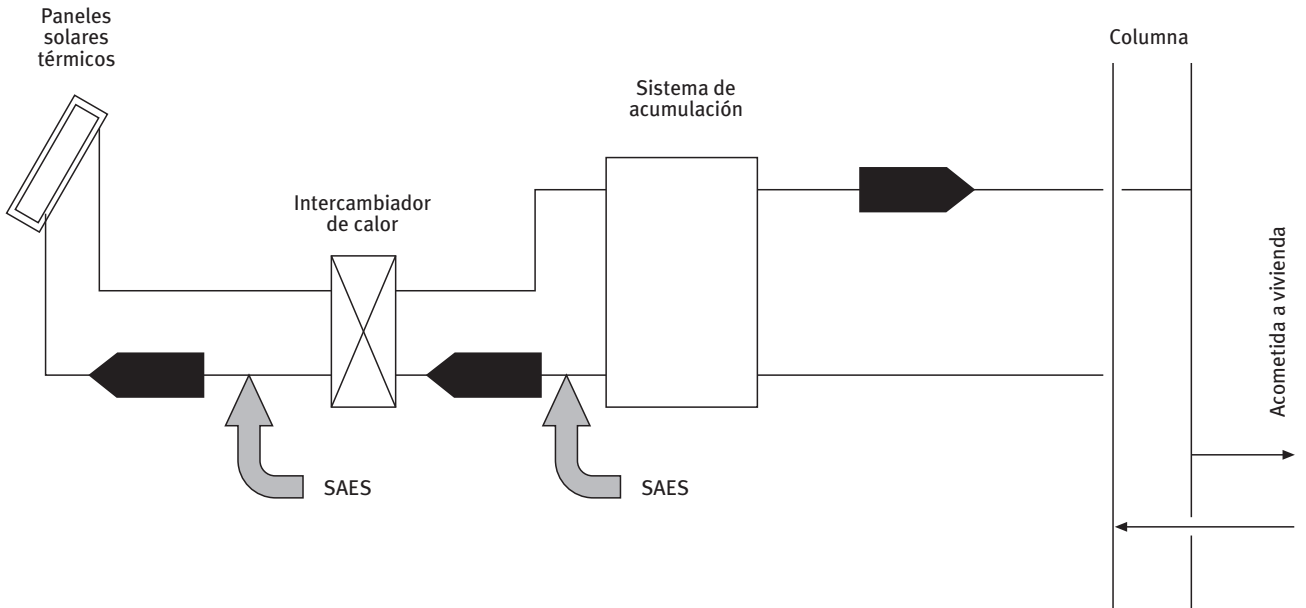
Preparación de ACS de sistema solar para viviendas con calderas murales
